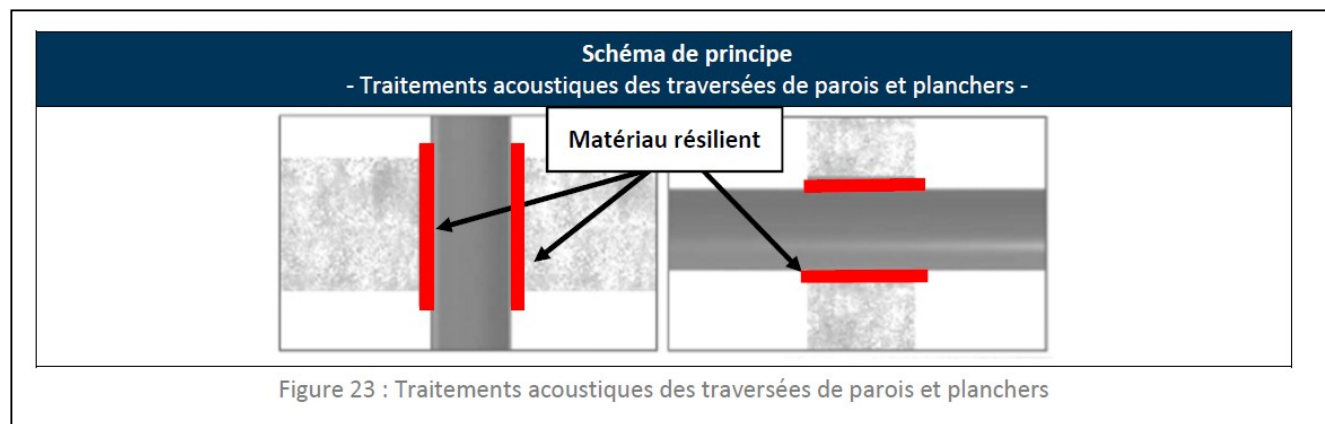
Traitements acoustiques des traversées de parois et planchers
